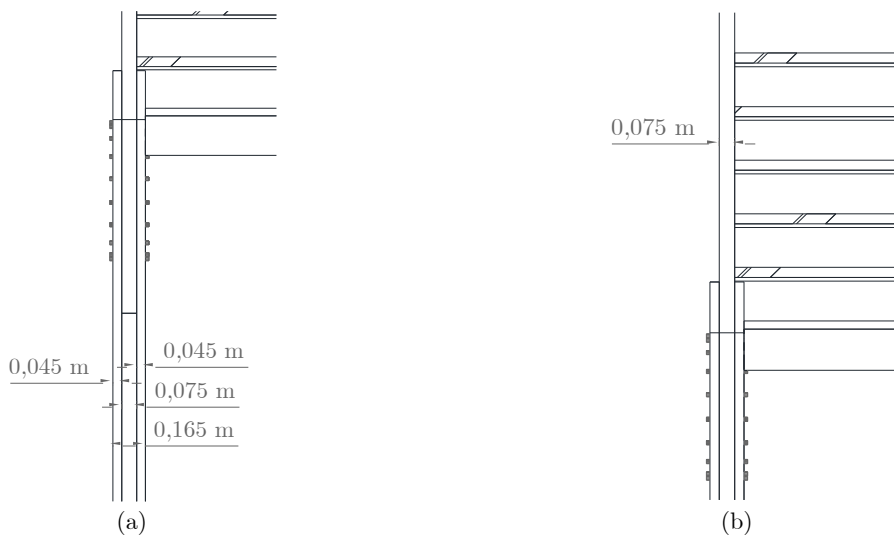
Pormenores sobre as espessuras: a) do pilar; b) da viga [Adaptado (Jular, 2018)].
